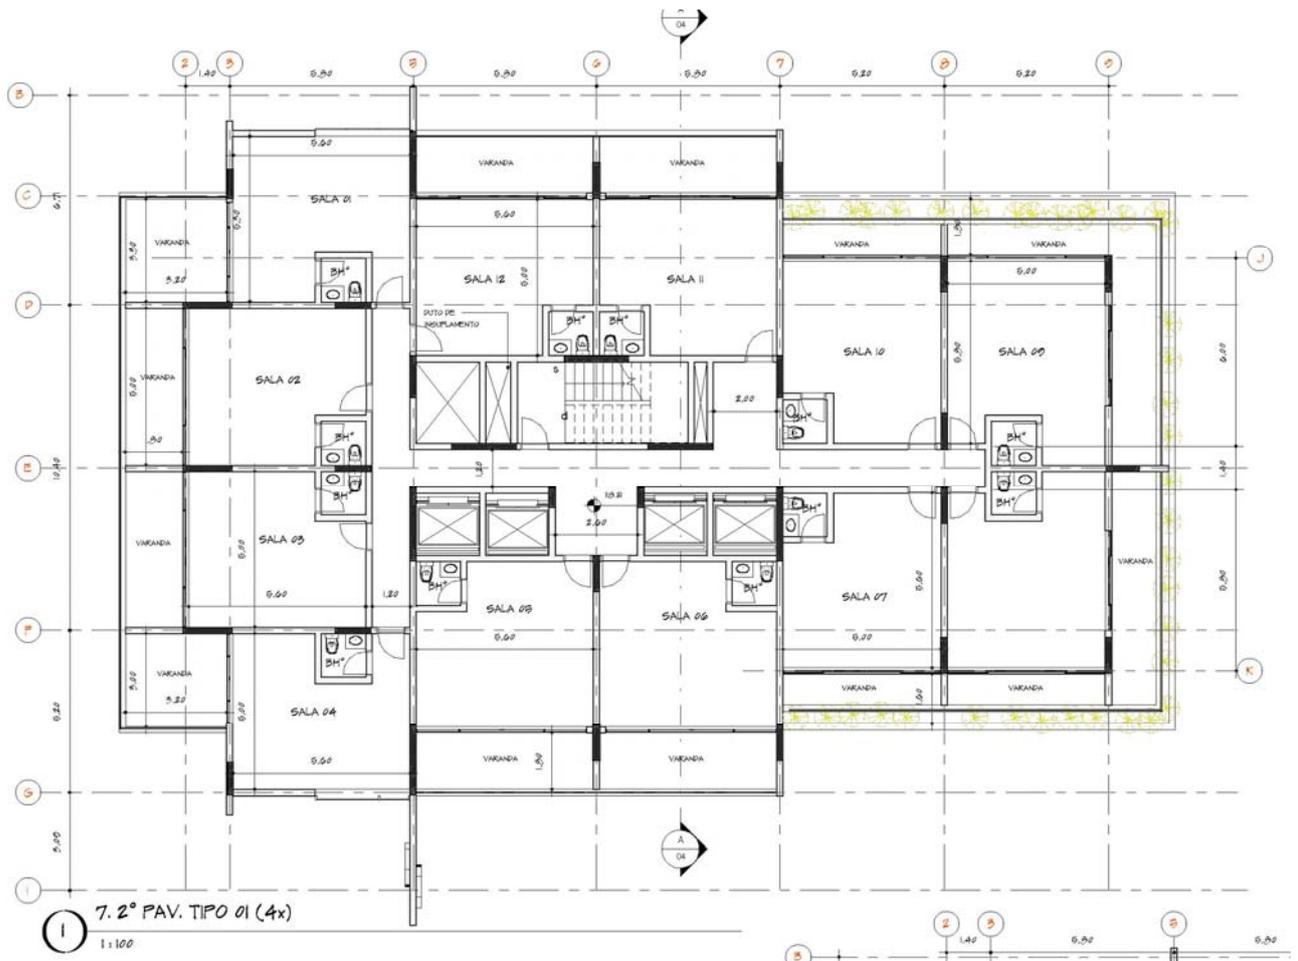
Planta Tipo 1 – 2º pavimento (4x)
